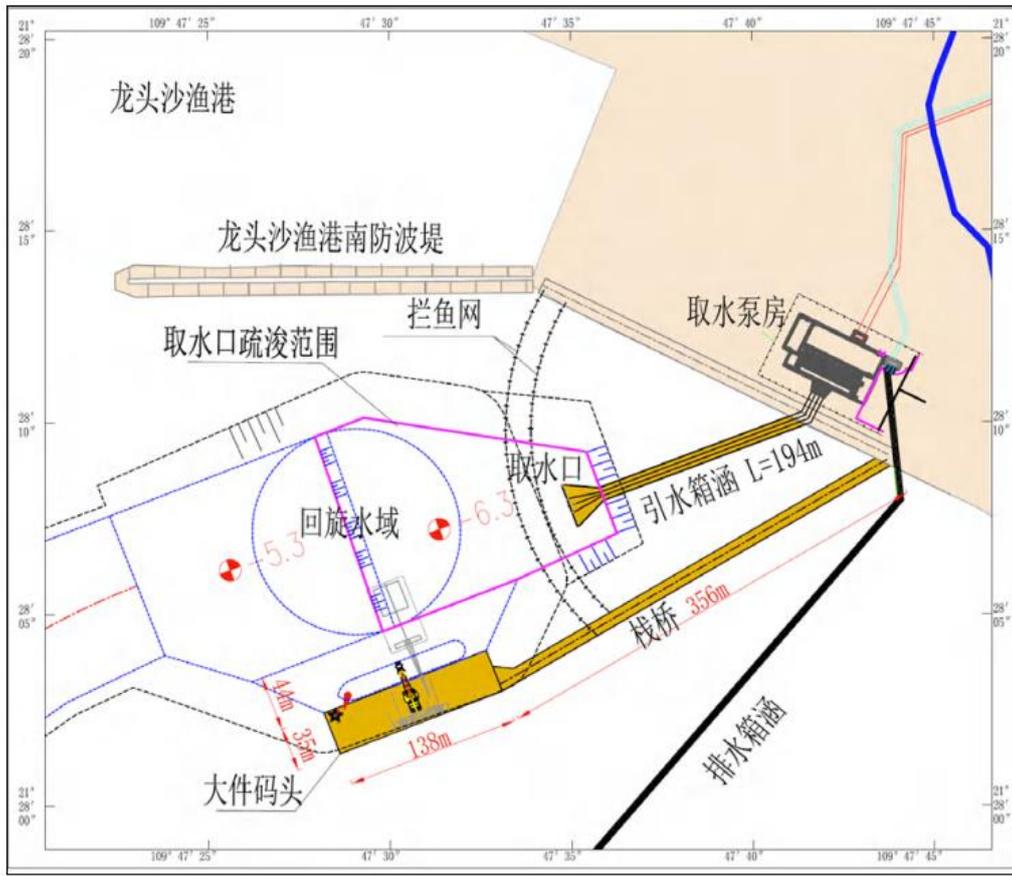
广东廉江核电项目一期工程码头总平面布置图
